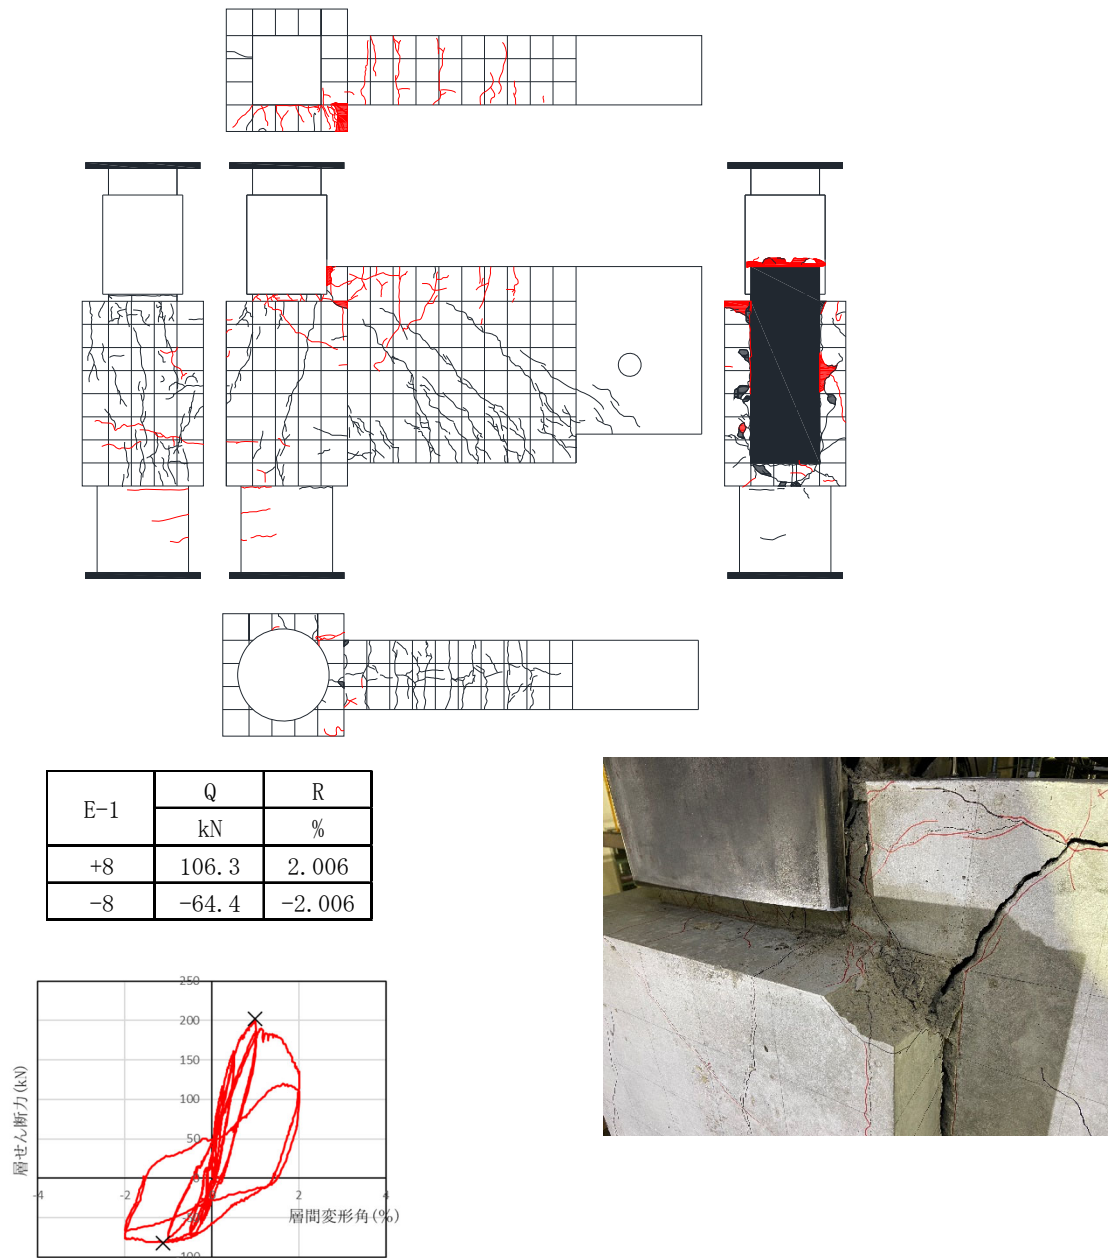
E-1 ひび割れ状況 (5Cycle)
